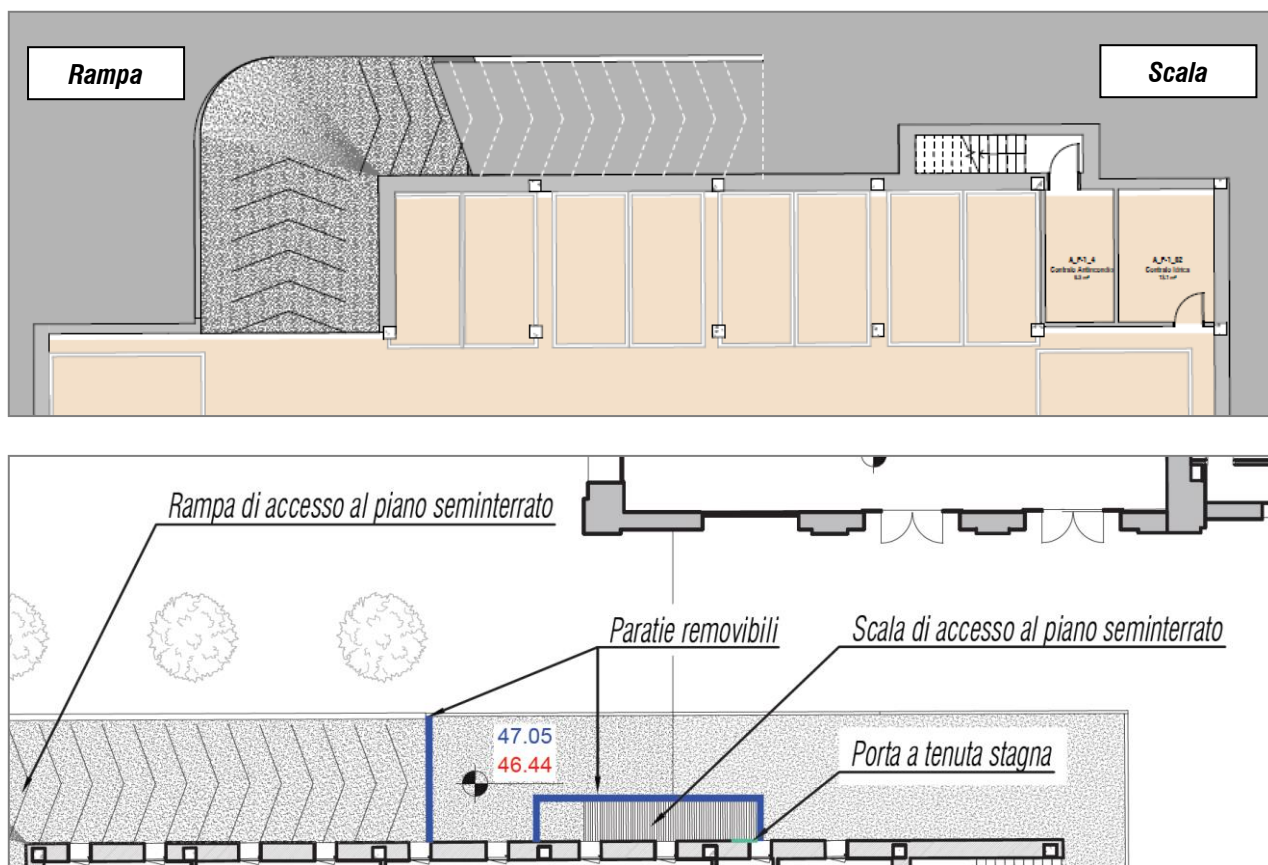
Individuazione degli accessi dall'esterno al piano interrato e degli interventi di difesa locale
